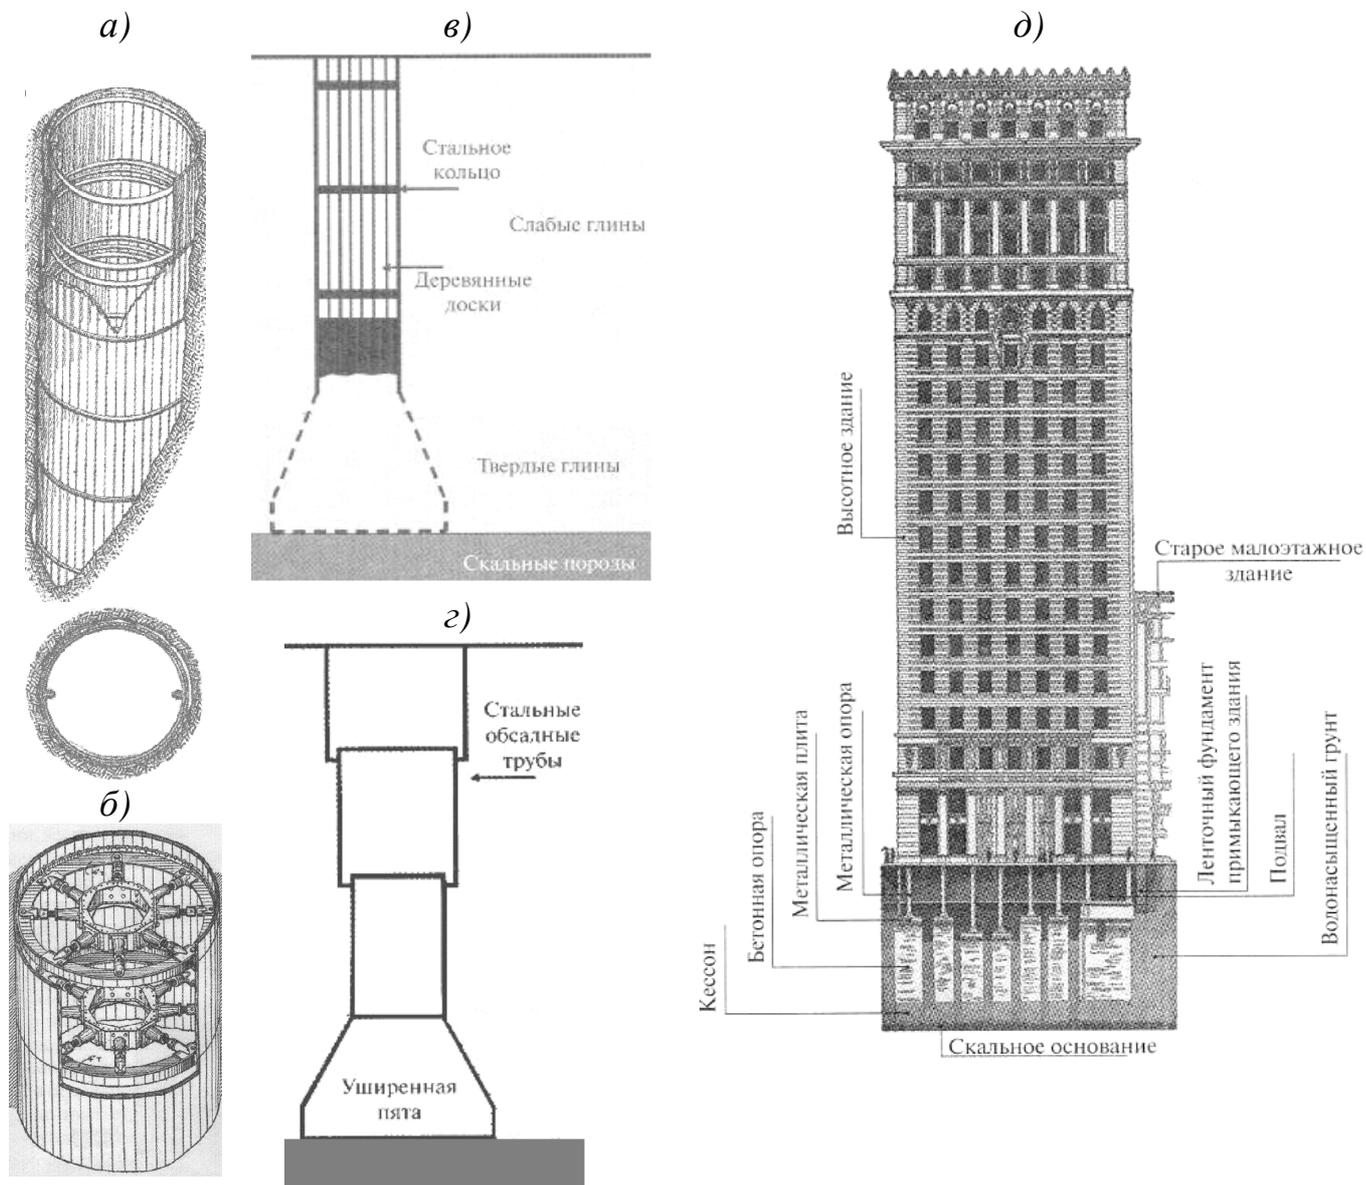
Способы устройства первых глубоких фундаментов под высотными зданиями: *а, б* – фундаменты в виде шахтных стволов с креплением стенок – вид сверху на открытый кессон (Нью-Йорк, 1914 г., глубина кессона 30 м, диаметр 2,9 м); *в, г* – глубокие шахтные опоры в качестве фундаментов под высотные здания по Чикагскому методу (*в*) и методом генерала Гоу (*г*); *д* – схема устройства фундаментов первых небоскребов Манхеттена на примере Бродвей Чамберз Билдинг (1900 г.)
